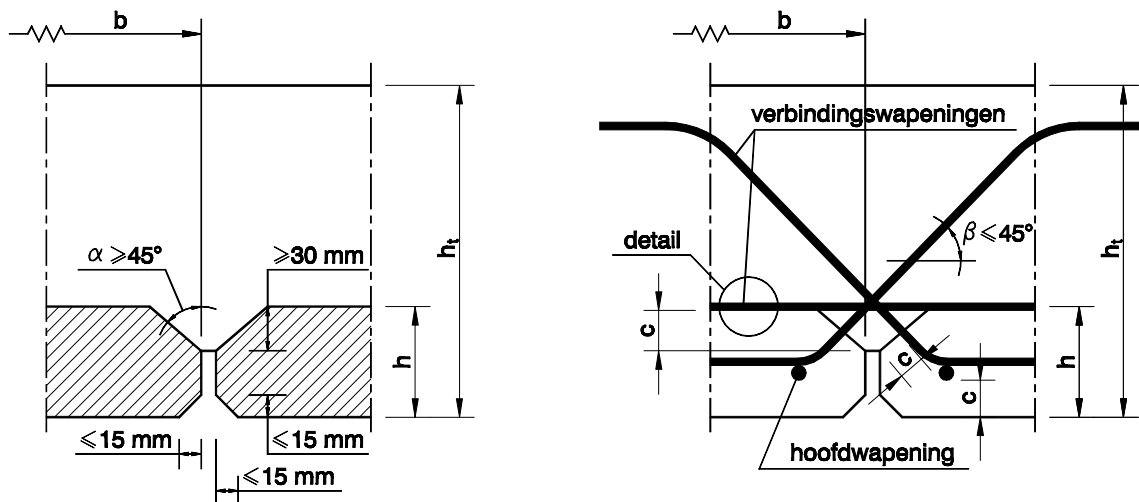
b - Breedplaten met afgeschuinde langstrand<sup>1</sup> bovenaan:
